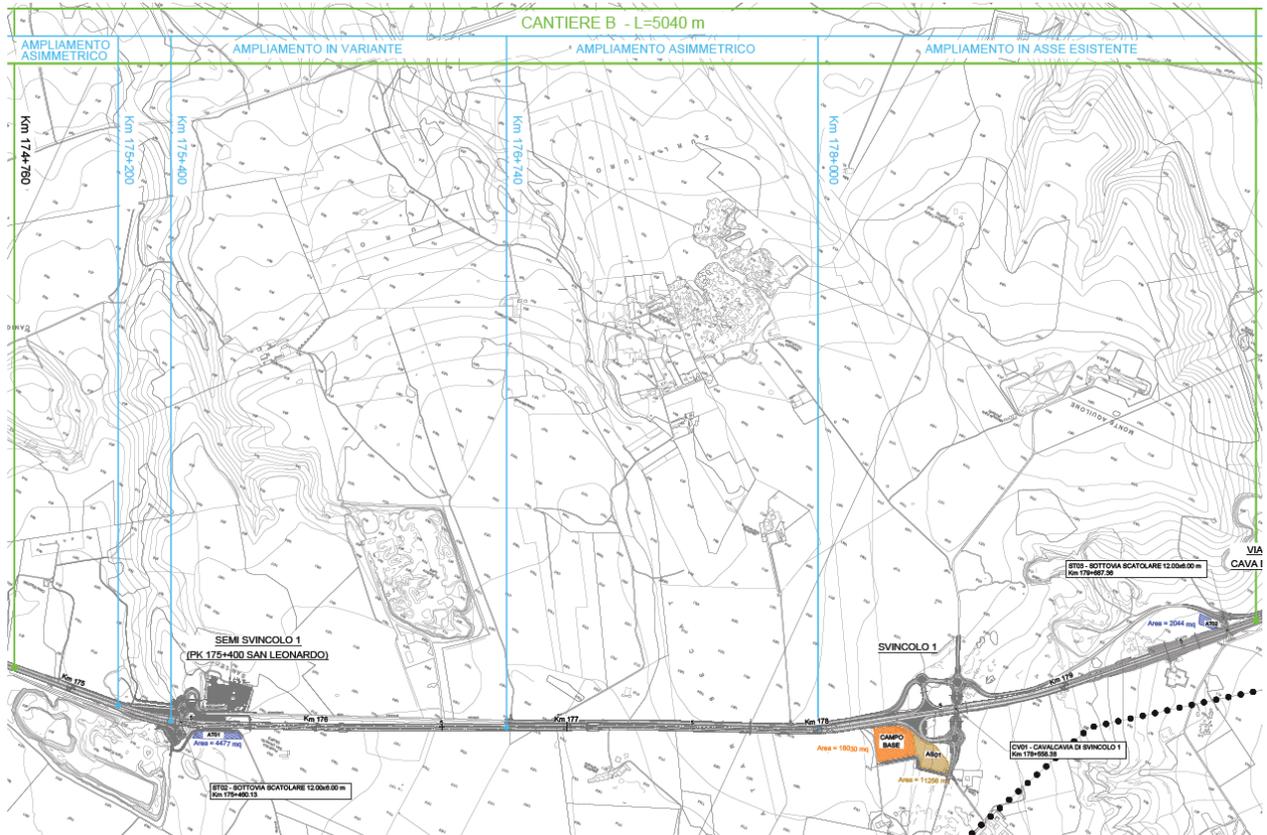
Stralci planimetrici con localizzazione Cantiere B
